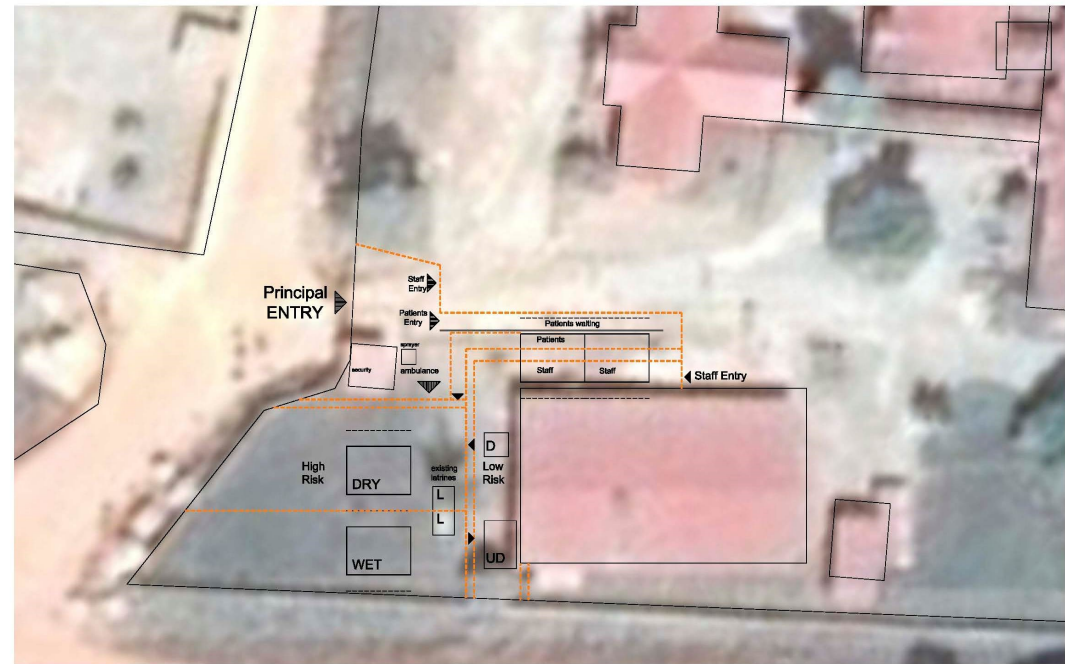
Propuesta de zona de aislamiento en el hospital de Koidu. Plano realizado en terreno por VSC.
